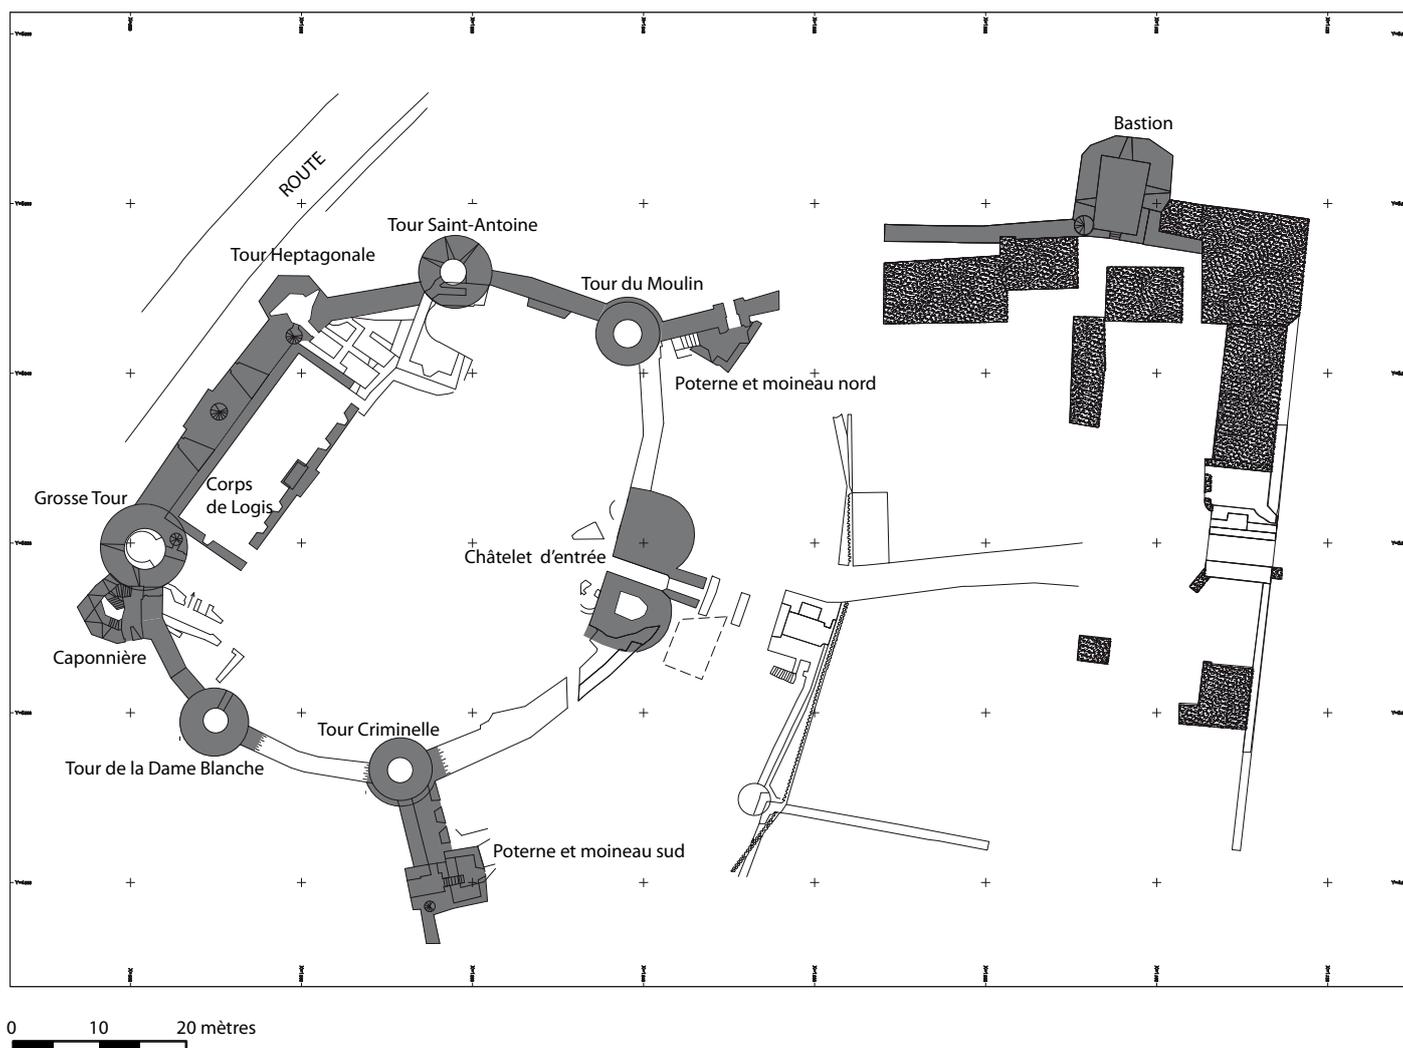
plan du château (DAO : A. CASAUBON, 2010, d'après Plan général du château, CHAM, Thierry Géhan, non publié)
